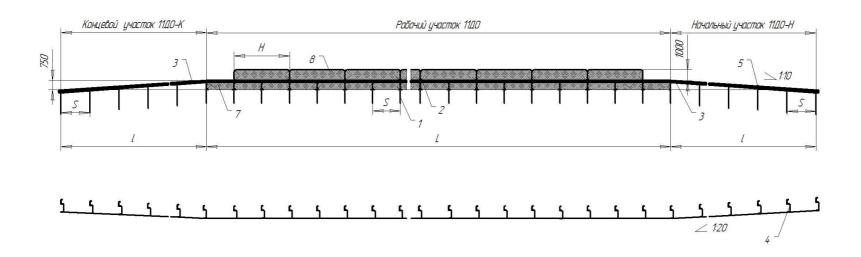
Схема сборки 11ДО/У5-У7(350-450)-0,75-разборное
